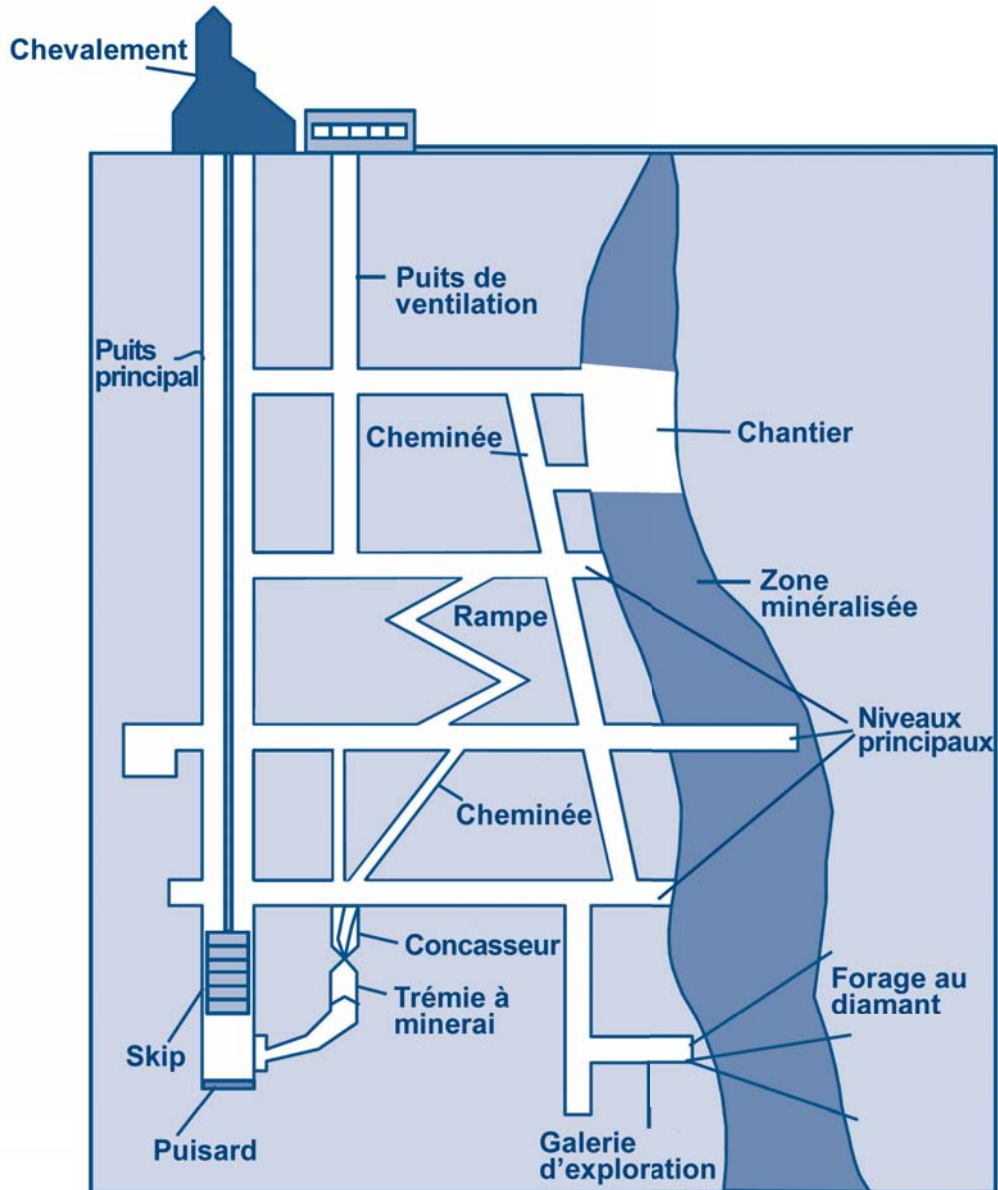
COUPE TRANSVERSALE D'UNE MINE SOUTERRAINE TYPE
